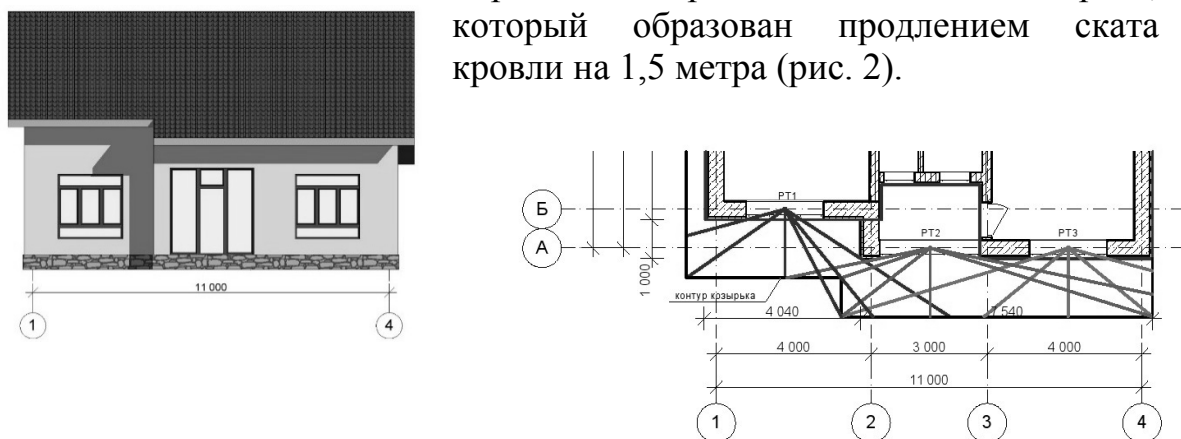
Южный фасад энергоэффективного дома и фрагмент плана 1-го этажа
